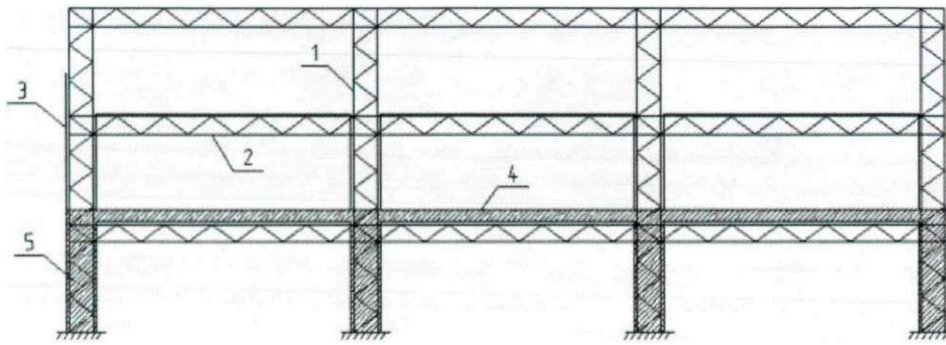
Схема формуючого каркаса із знімними ригелями 1 - колони формуючого каркаса; 2 - знімні ригелі; 3 - опалубка; 4 - монолітна плита перекриття; 5 - колона після бетонування
